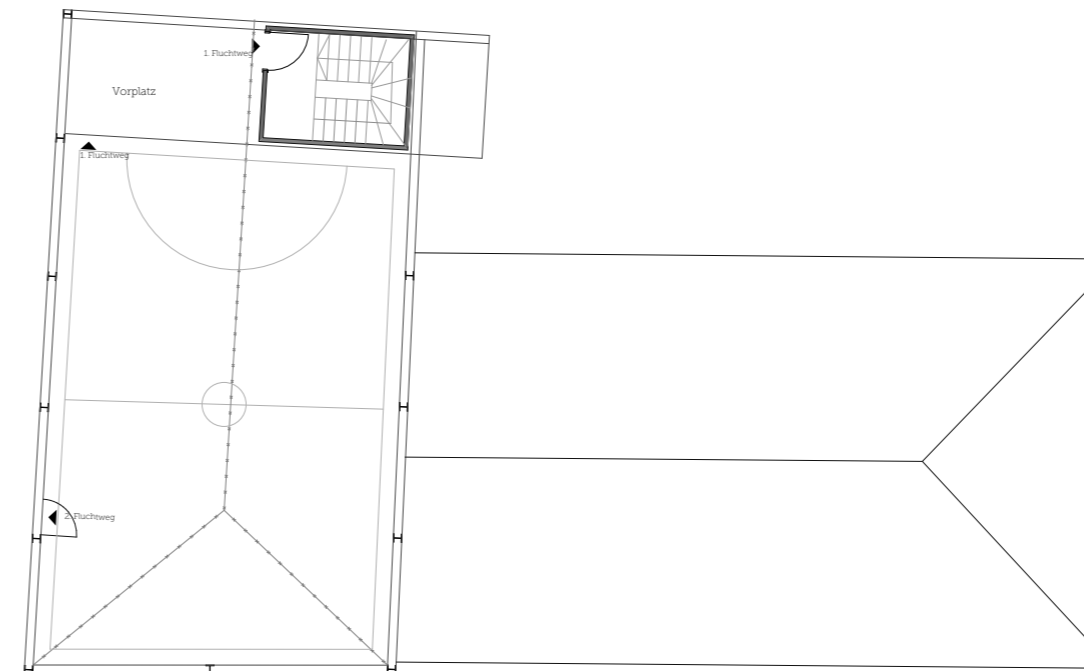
Dachsportplatz, Grundriss © hirner & riehl architekten & stadtplaner partg mbb
